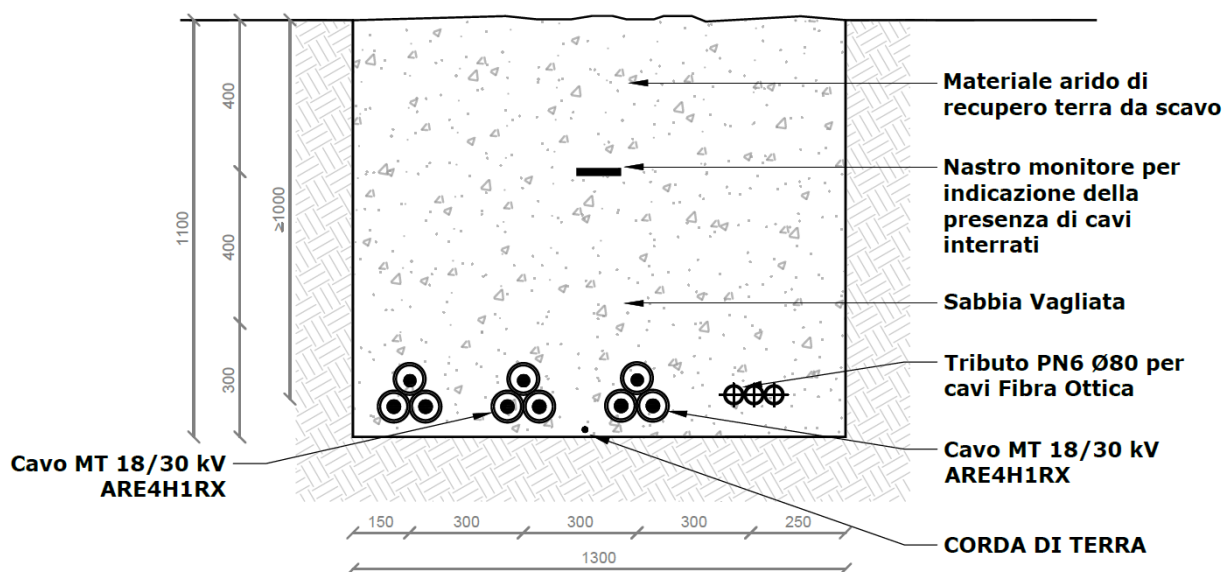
Sezione tipo posa cavidotti 30 kV su campo/strada sterrata
